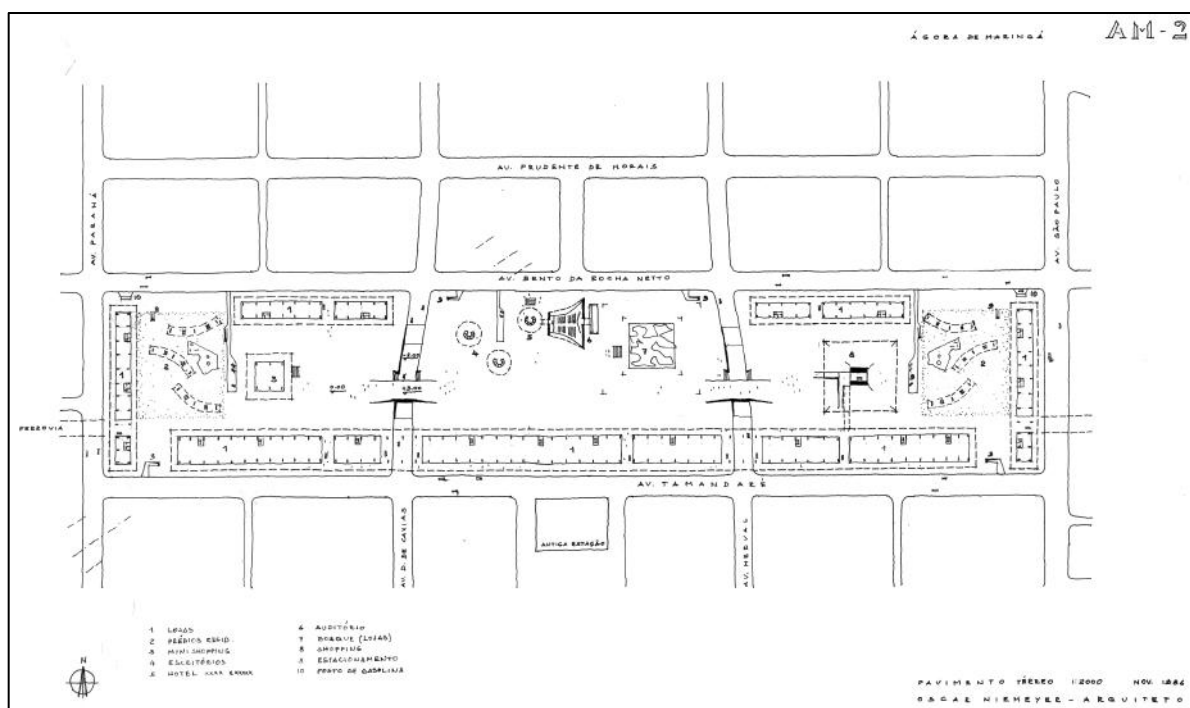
“Projeto Ágora” de 1986. Pavimento térreo.
